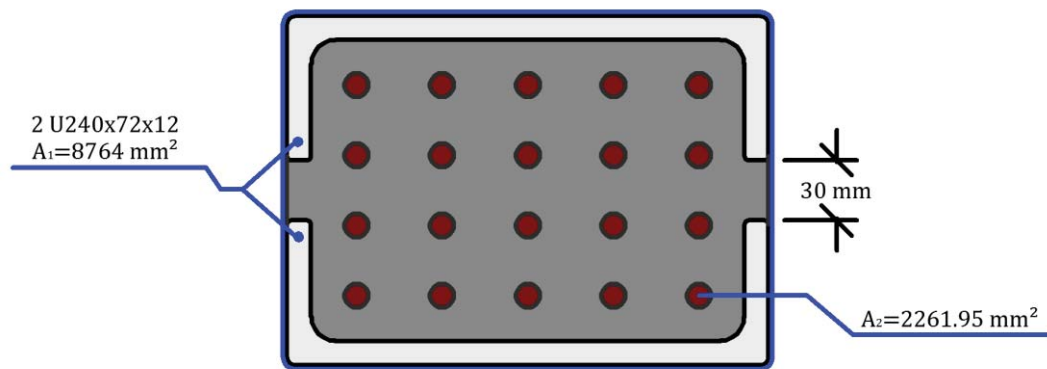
Secção transversal das barras tracionadas do núcleo de rigidez
